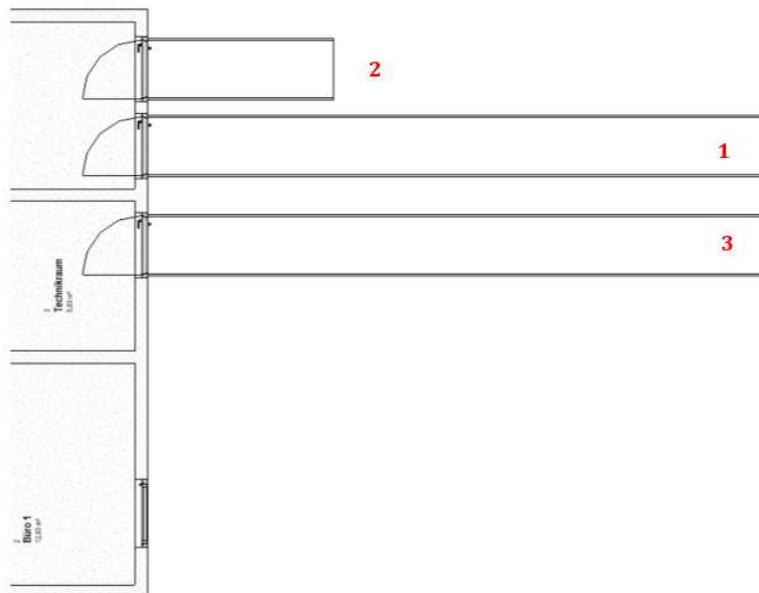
Grundriss der Rampen BIM Modell OIB RL 4 – 2.2.1
